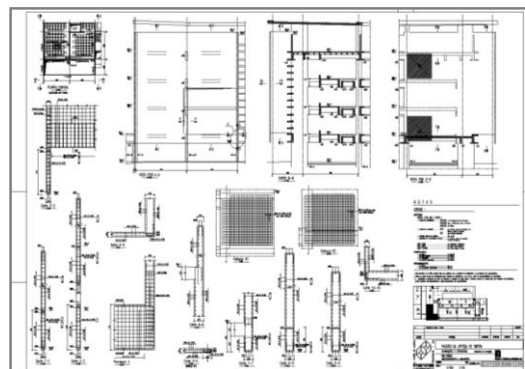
Pormenorização dos volumes de paredes destacados da fachada
